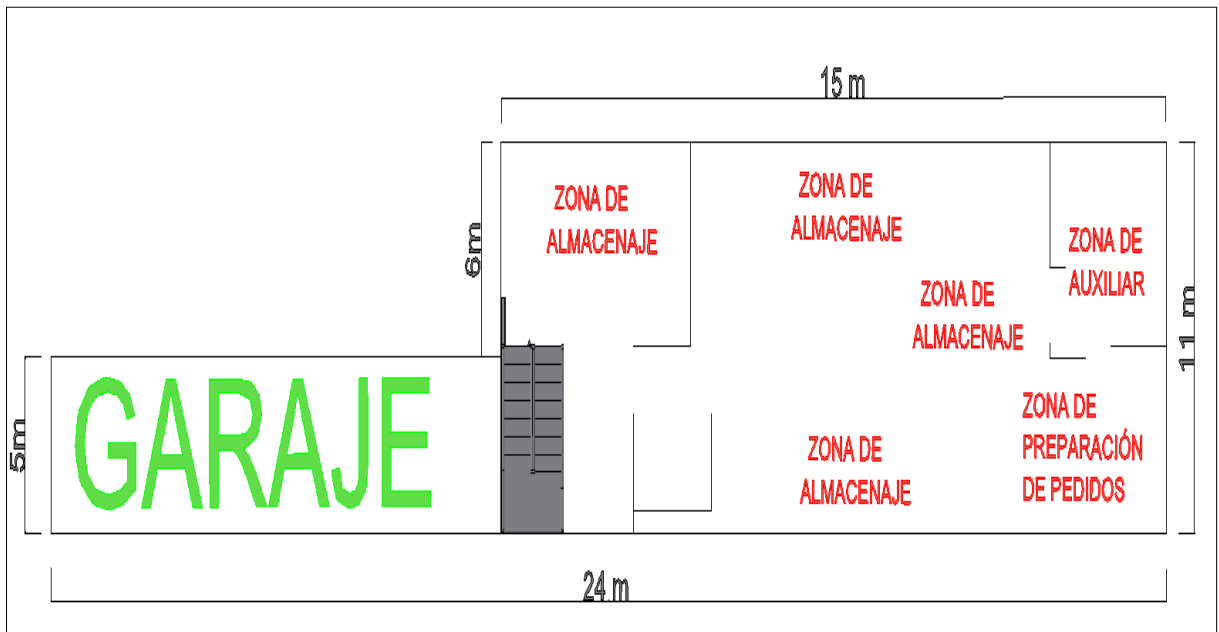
Vista superior y dimensiones de la primera planta (plano 1)
